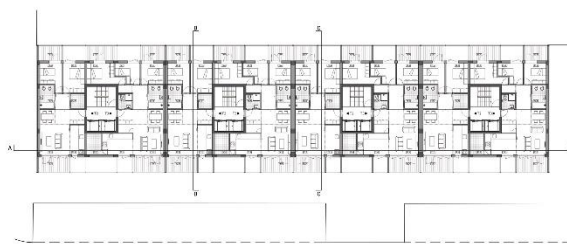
Planta do Piso Tipo do Edifício 2 e 9
